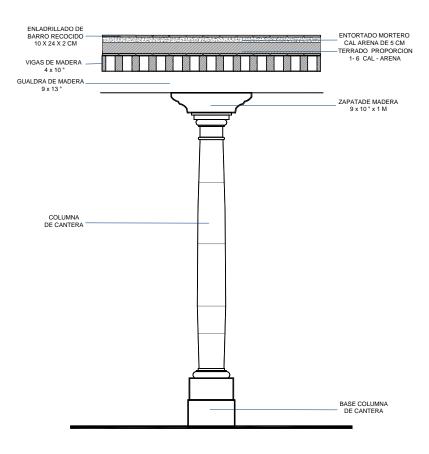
Vista del corte de la cubierta del corredor el apoyado en la columna de cantería
